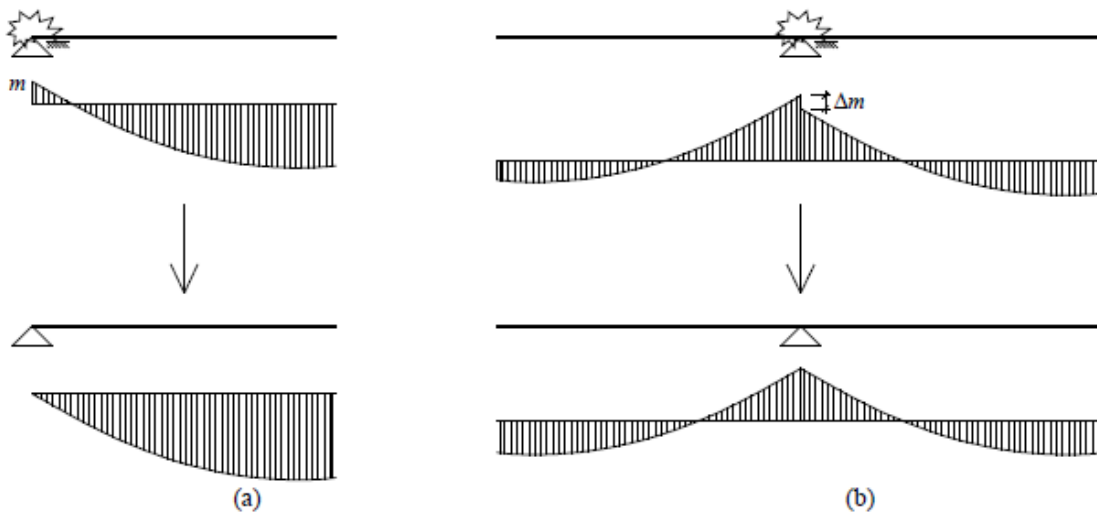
Simplificação de modelos de cálculo de lajes de pavimento para zona de apoio [4]
